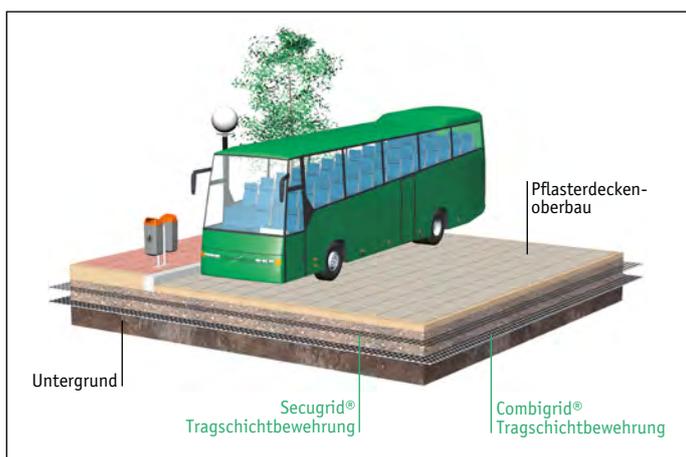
Tragschichtbewehrung für große Lasten auf wenig tragfähigem Grund
